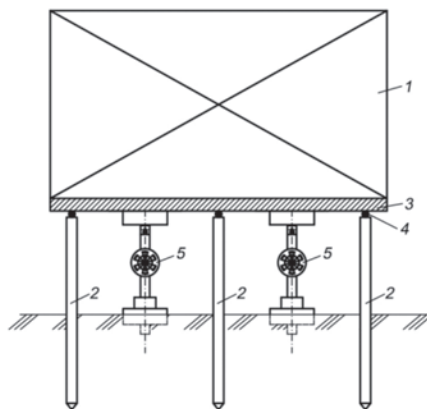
Здания на свайных фундаментах с высоким расположением ростверков, с шарнирным соединением их со сваями и с СЭСТ. 1 – здания с жесткой конструктивной схемой, 2 – сваи, 3 – ростверк, 4 – шарниры между сваями и ростверком, 5 – СЭСТ.
